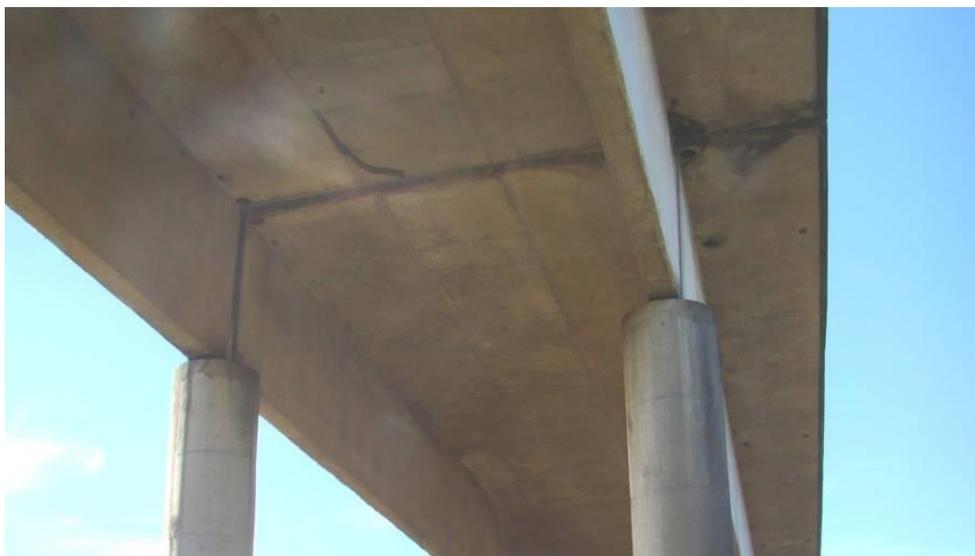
Vista inferior de la viga principal Pi del sector A del Puente General Artigas
